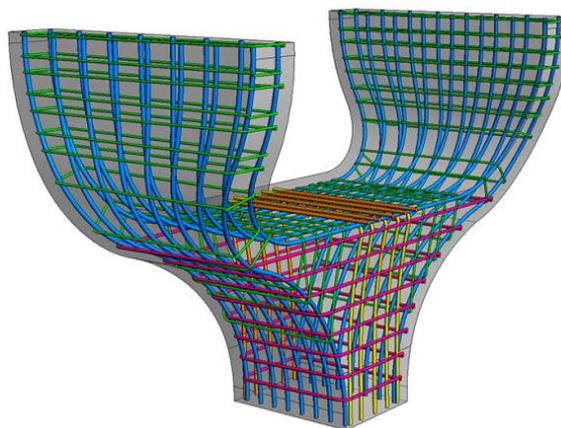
Exemplo da modelação de armaduras em ambiente BIM [5]
